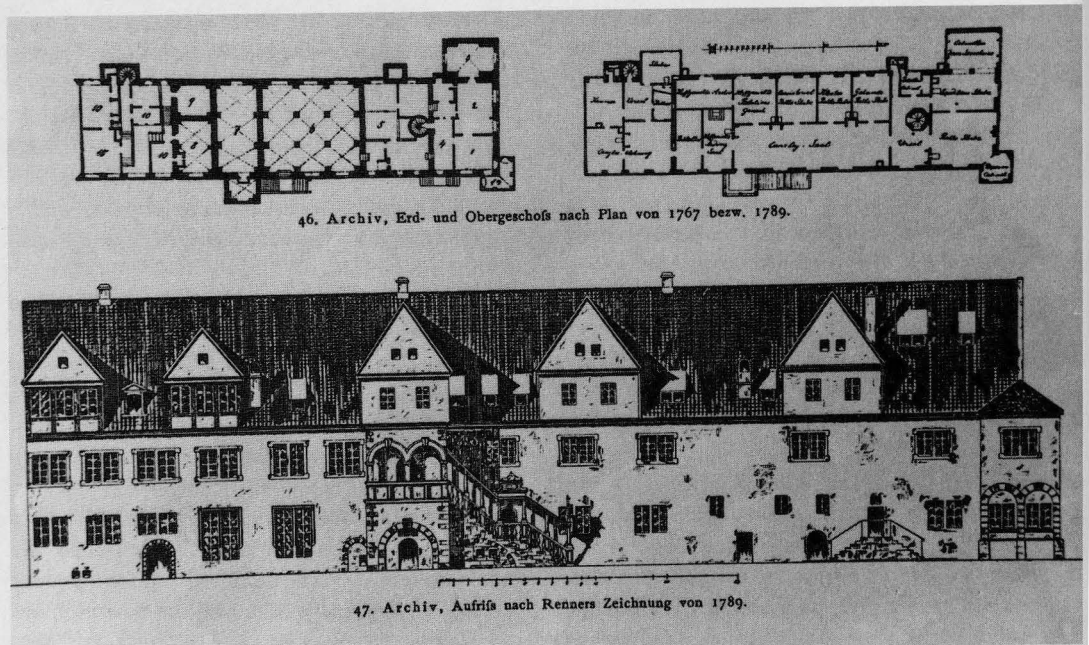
Neue Kanzlei, Aufriss und Grundrisse des 18. Jahrhunderts (nach Meier/Steinacker, S. 145)
